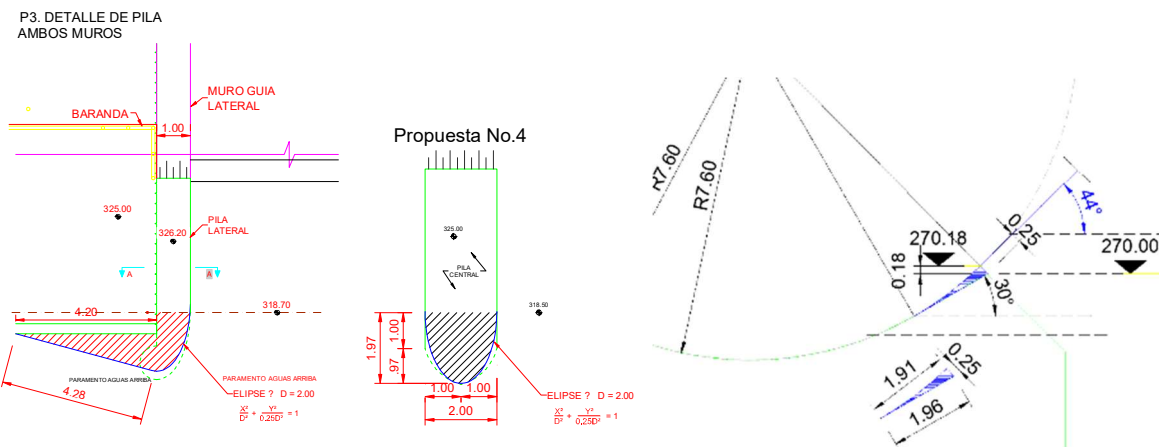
Vista en planta de la geometría de modificación de pilas laterales y centrales, y modificación del labio del deflector central propuestas para la serie 8.
